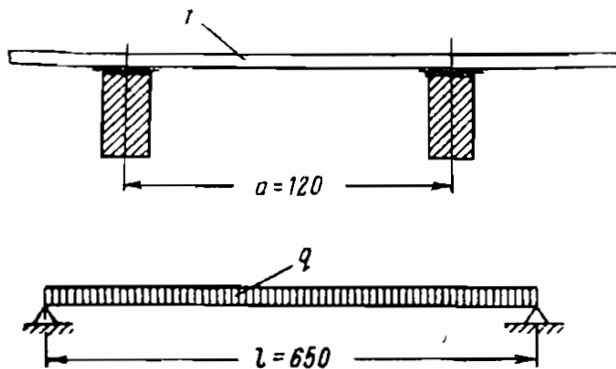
Конструктивная схема перекрытия и расчетная схема
